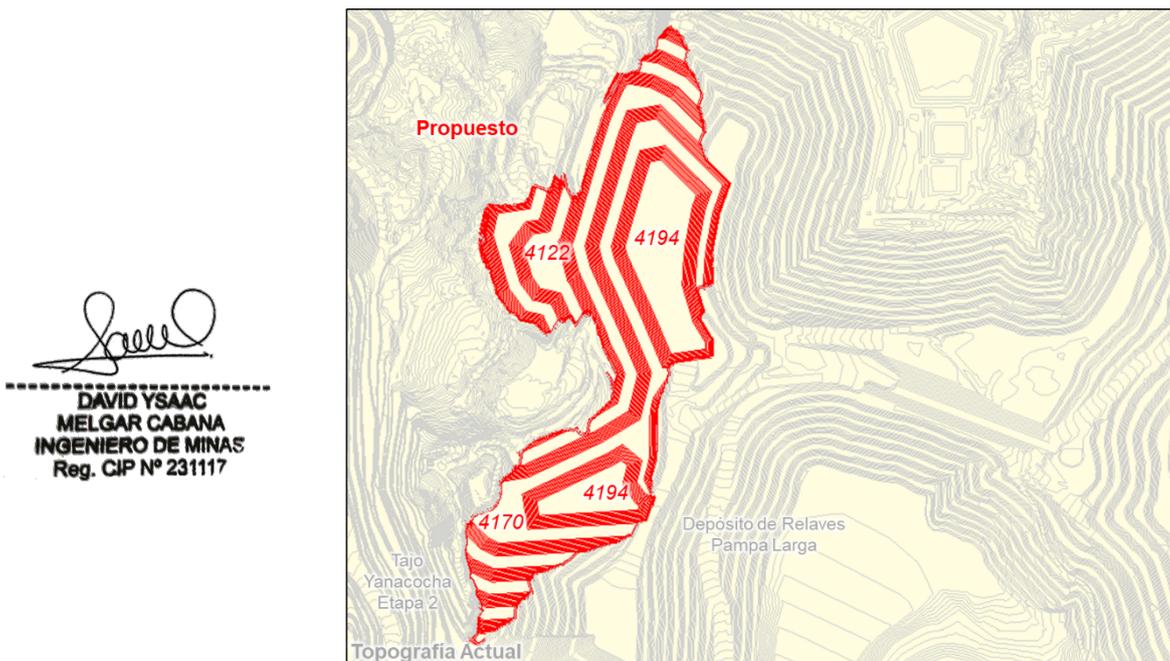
Plan de descarga del Depósito de Desmonte Mirador – Corte 1
